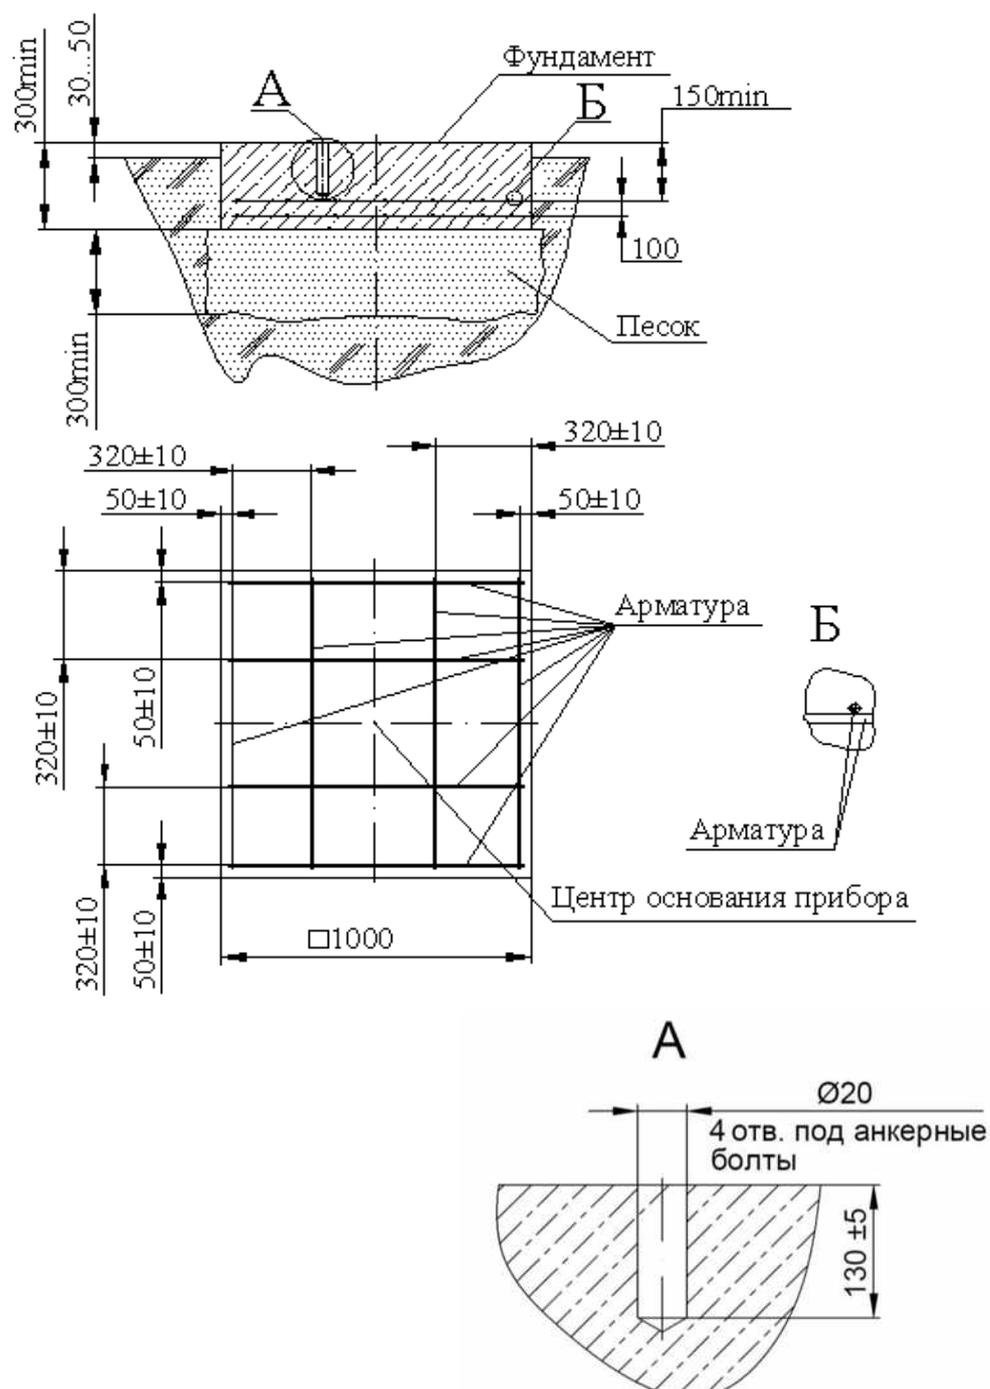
Рекомендуемый вид фундамента для установки прибора на устойчивых грунтах
